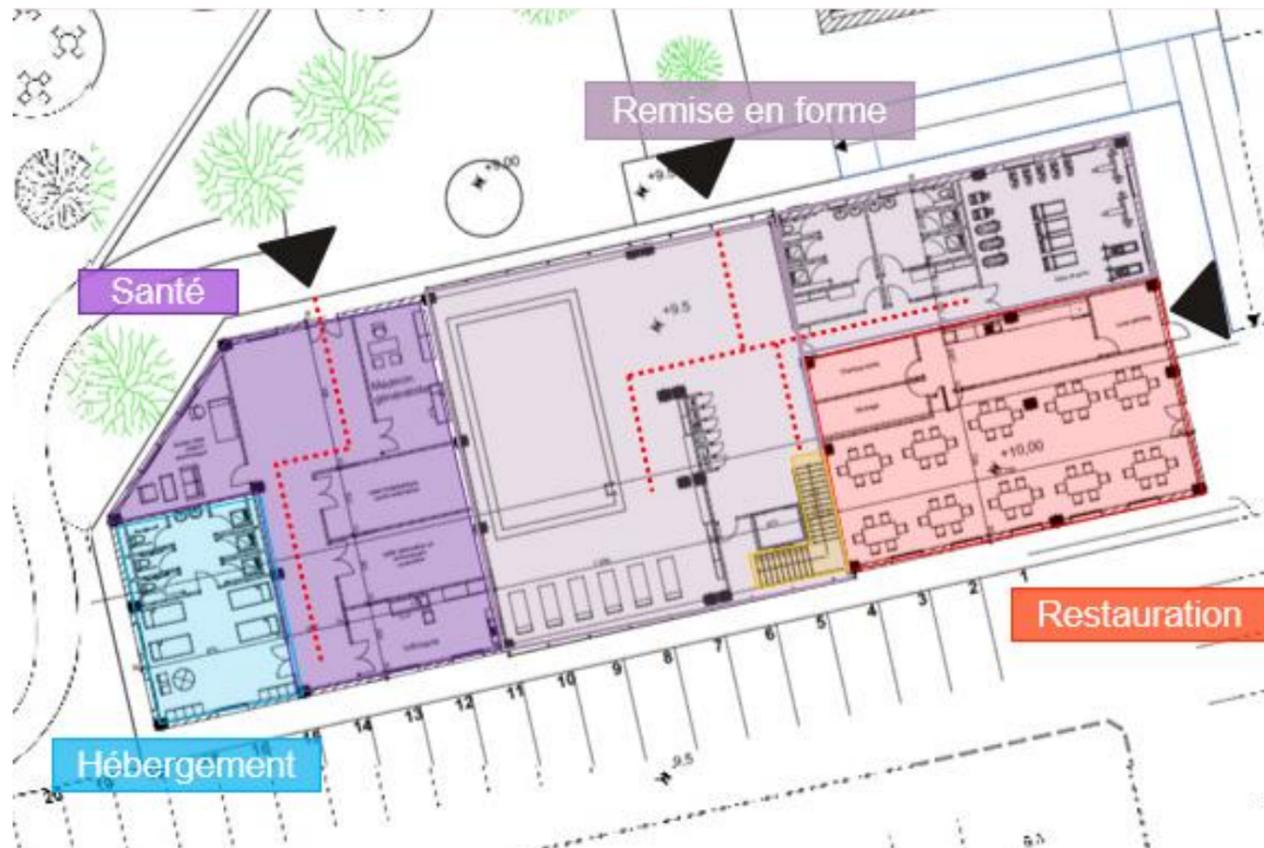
Plan du rez-de-chaussée – Bâtiment commun
